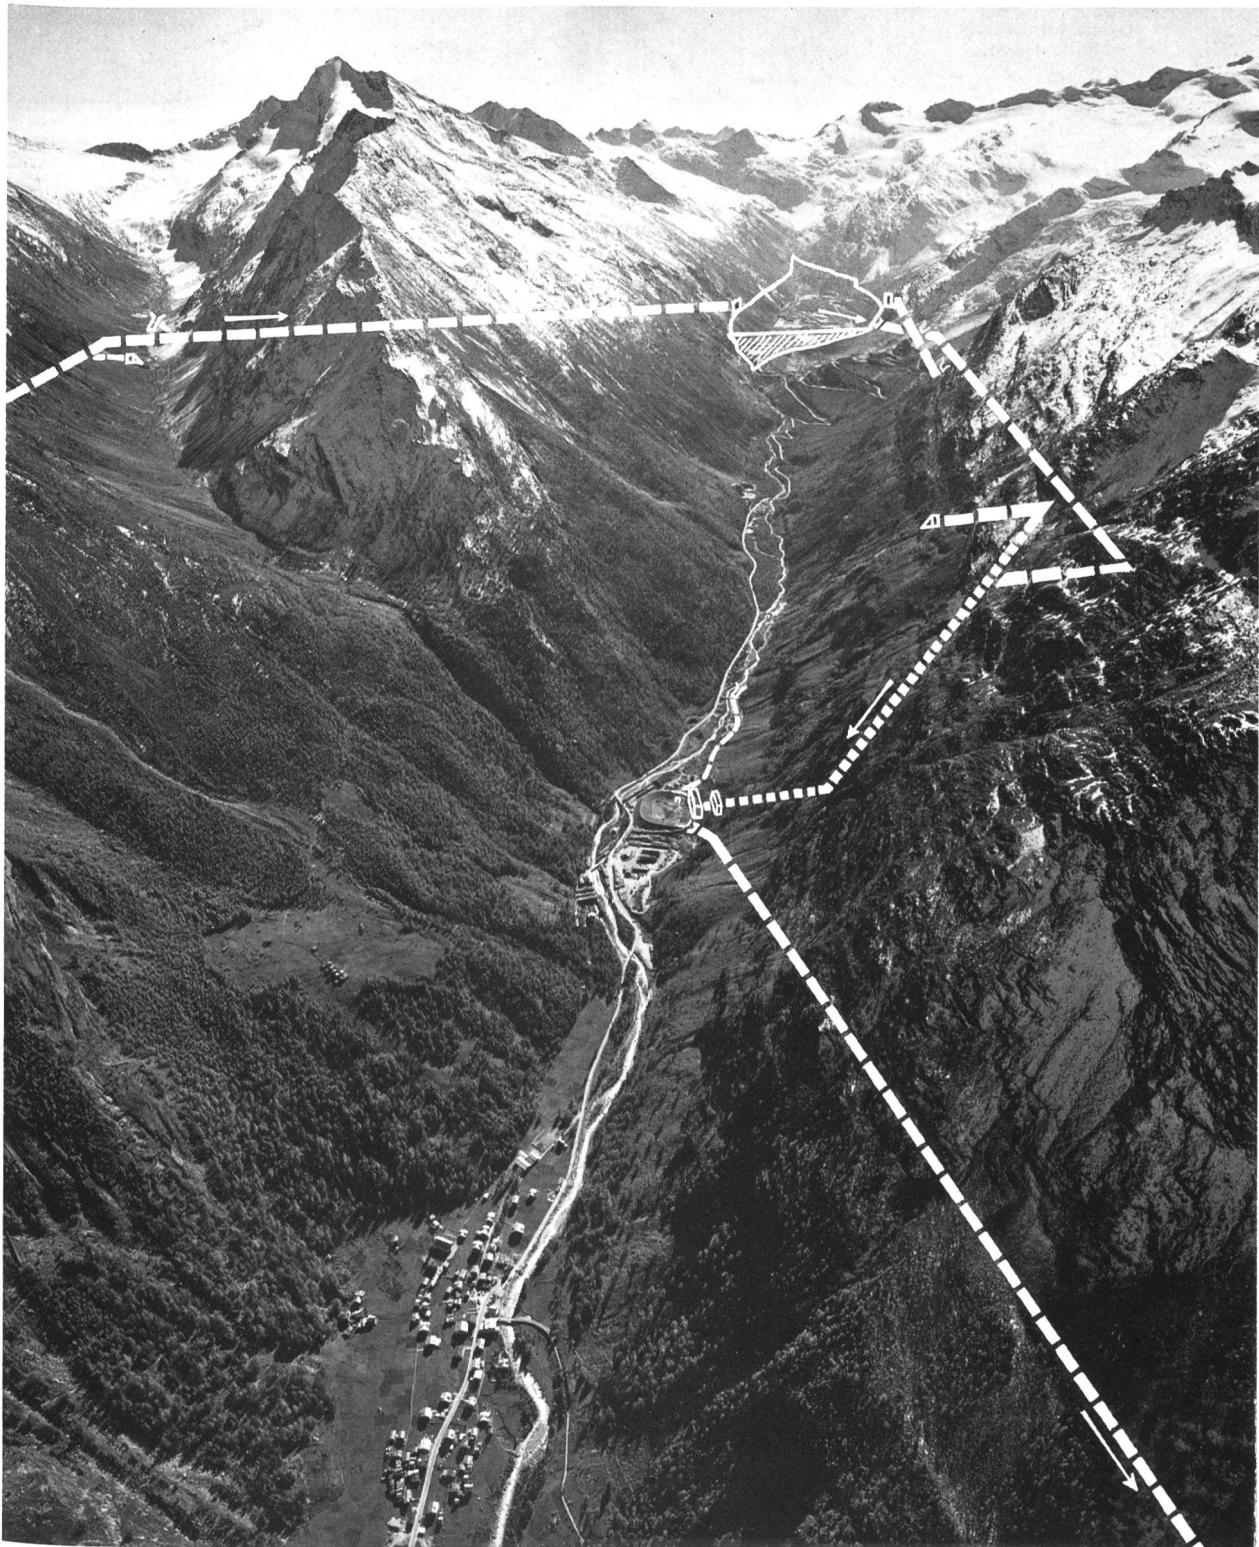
Flugaufnahme des oberen Saaser Tales, Richtung Süd, Oktober 1963
